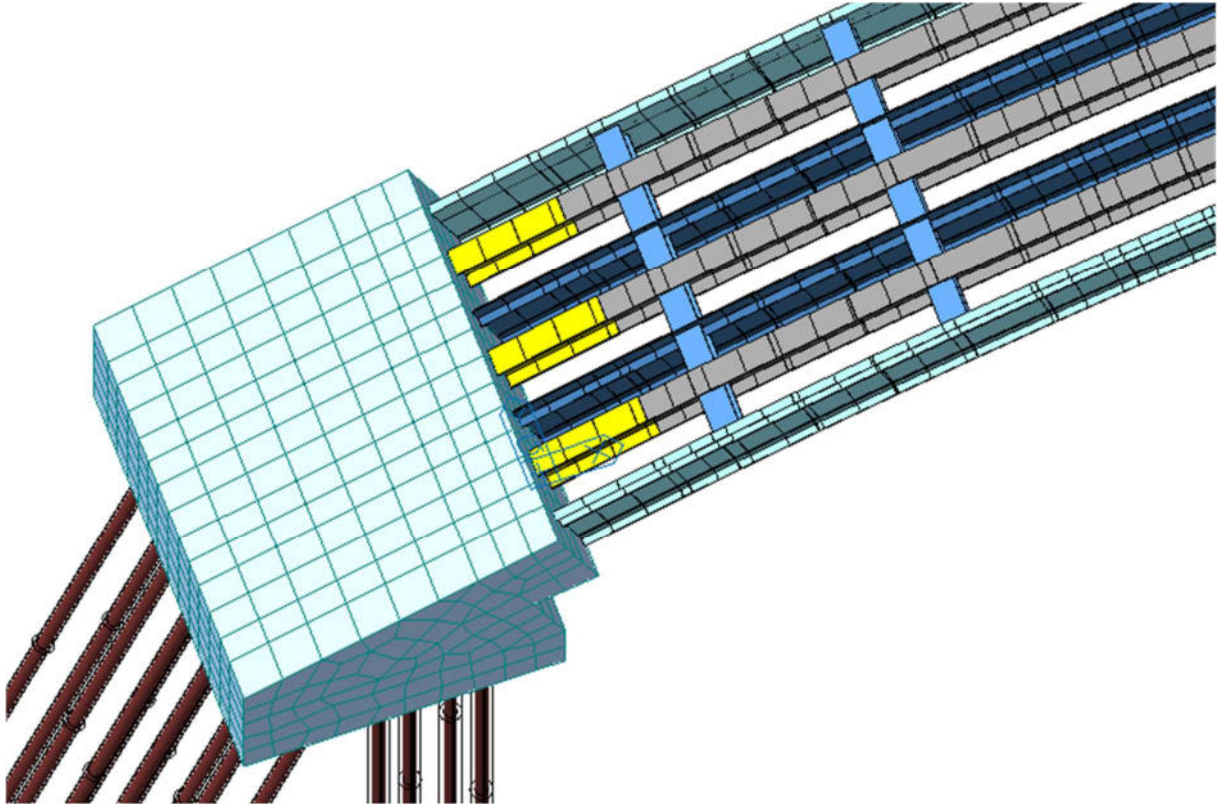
Modello FEM vista prospettica dettaglio strutture principali
